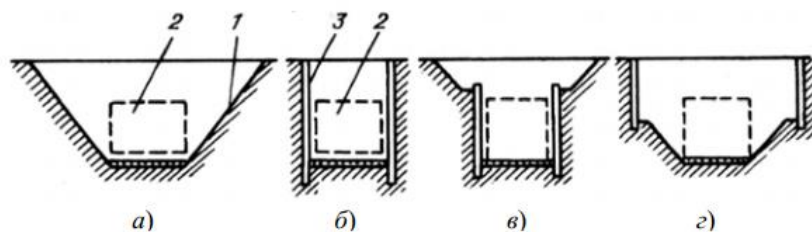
Схемы конструкций котлованов: 1 – откос; 2 – тоннель; 3 – свая
